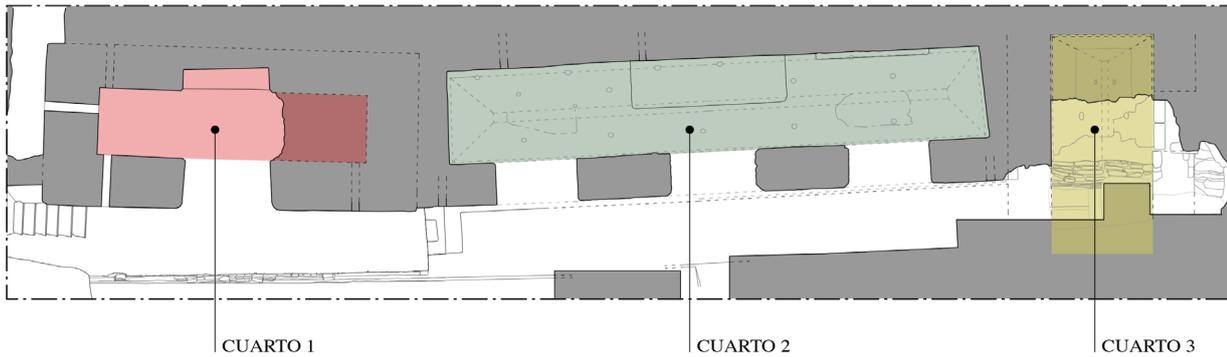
Planta de la subestructura con la identificación de cada estancia.
